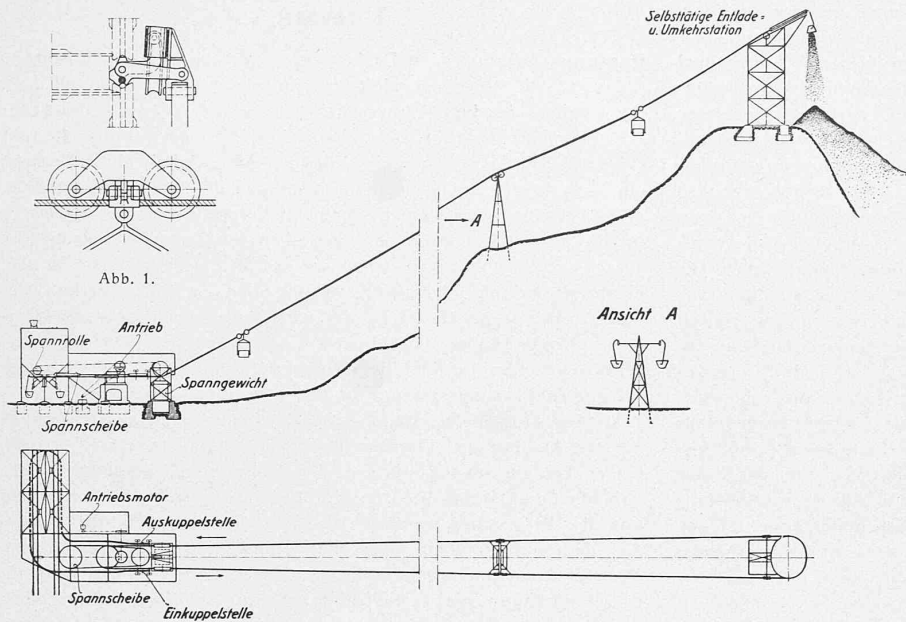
Grundriss und Längsprofil einer als Einseilbahn ausgeführten Haldenabsturzbahn.
